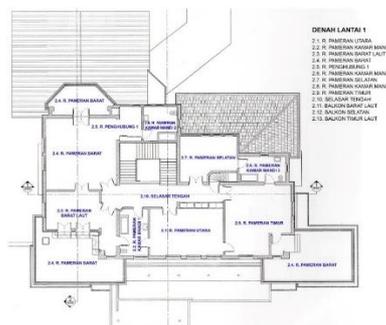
Denah Rumah Tinggal (Lantai Dasar)
